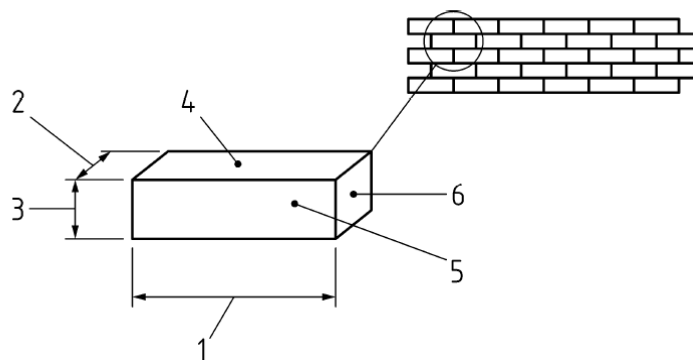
Emërtimi i detajeve të elementeve të muratës
